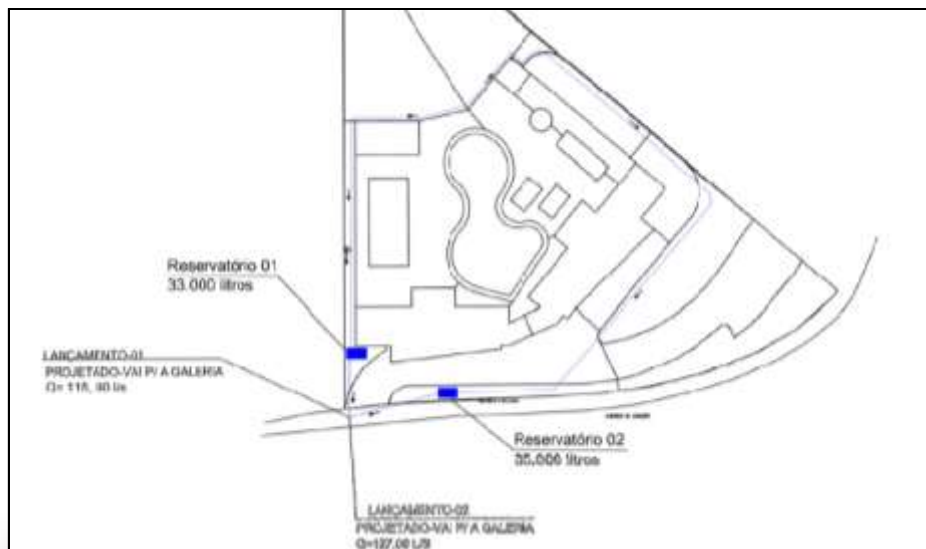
Croqui dos pontos de lançamento da drenagem do Green Garden e localização dos dispositivos de retardo.
